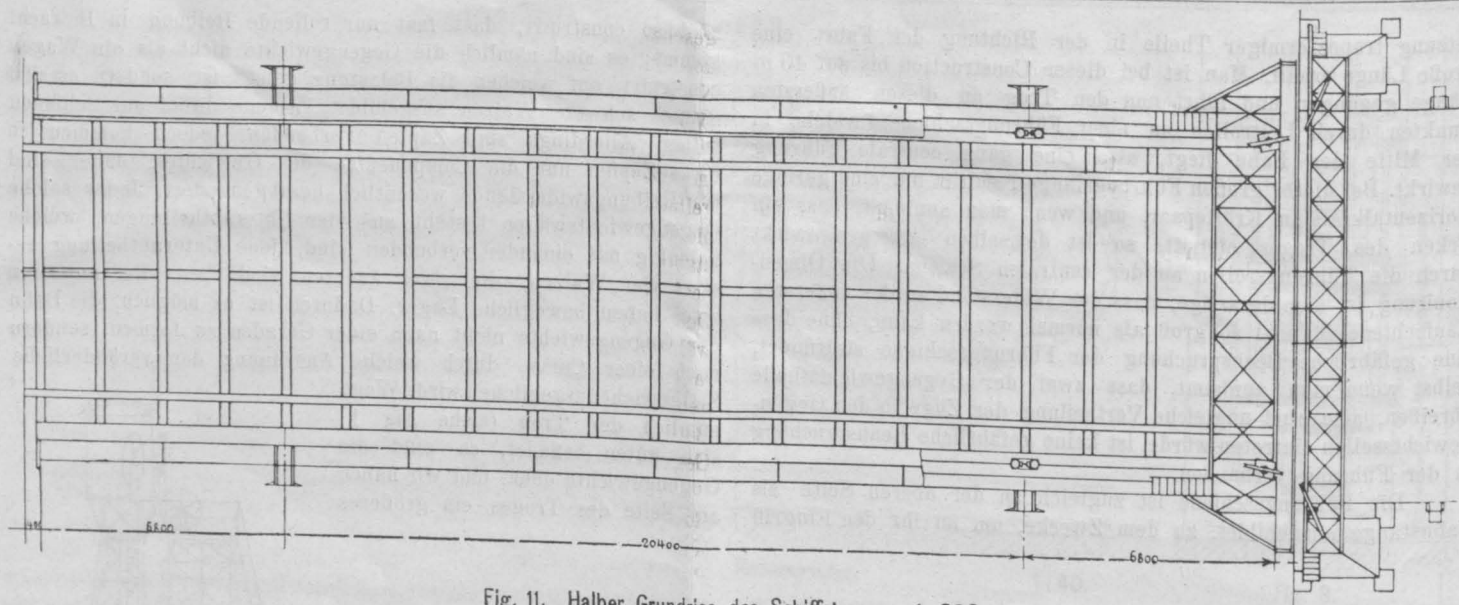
Halber Grundriss des Schiffstoges. 1:200.
